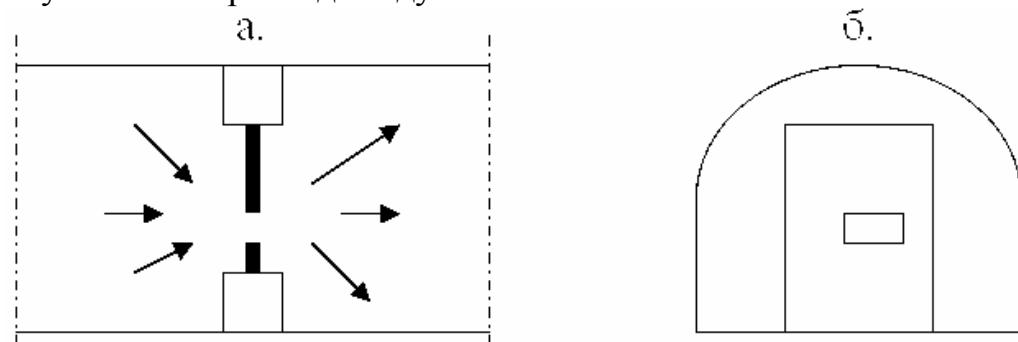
Вентиляционное окно в продольном (а) и поперечном (б) сечении выработки
